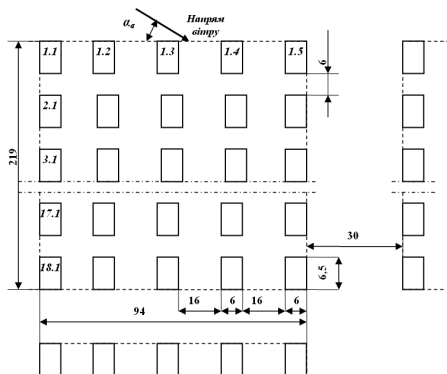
План кварталу складу круглих лісоматеріалів штабельного зберігання
